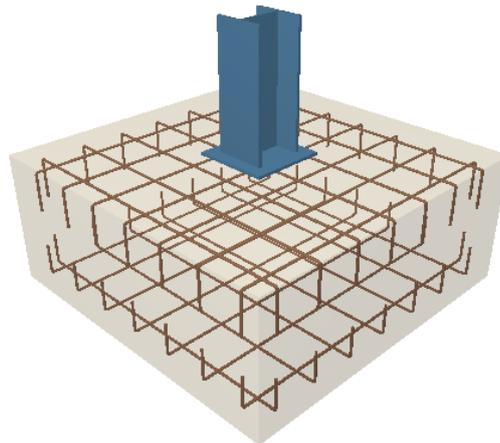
Zapata Z3. Fuente: CYPE 2017
